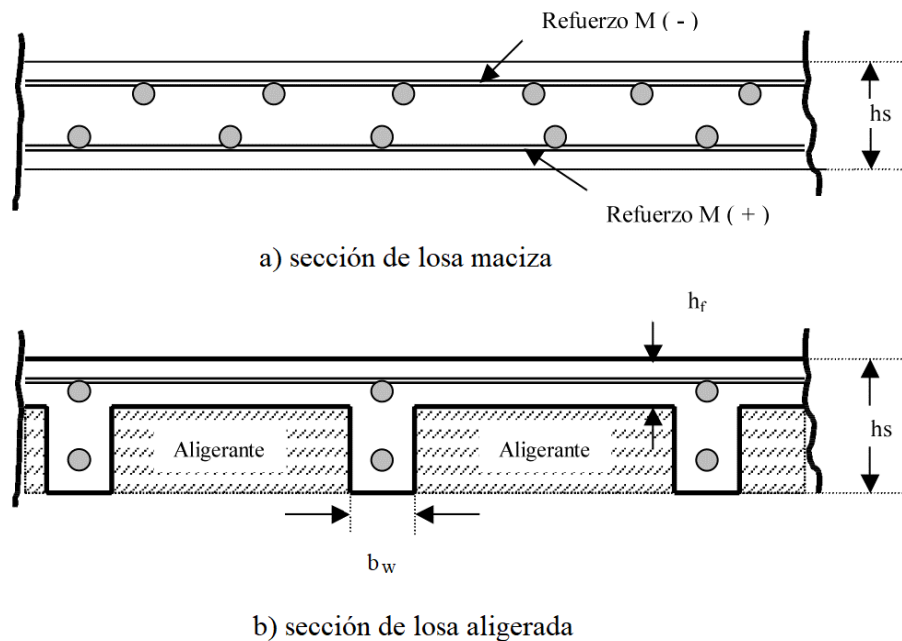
Sección de Losa Maciza y Aligerada de Hormigón Armado.
